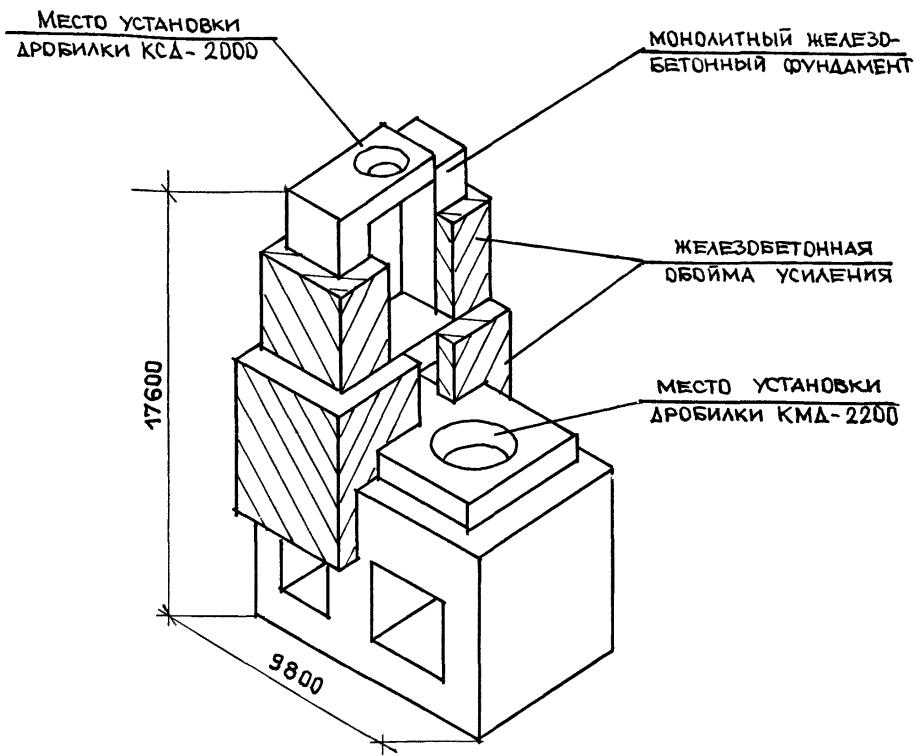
Усиление железобетонной обоймой фундамента с массивной верхней частью подвального типа под две конусные дробилки.
